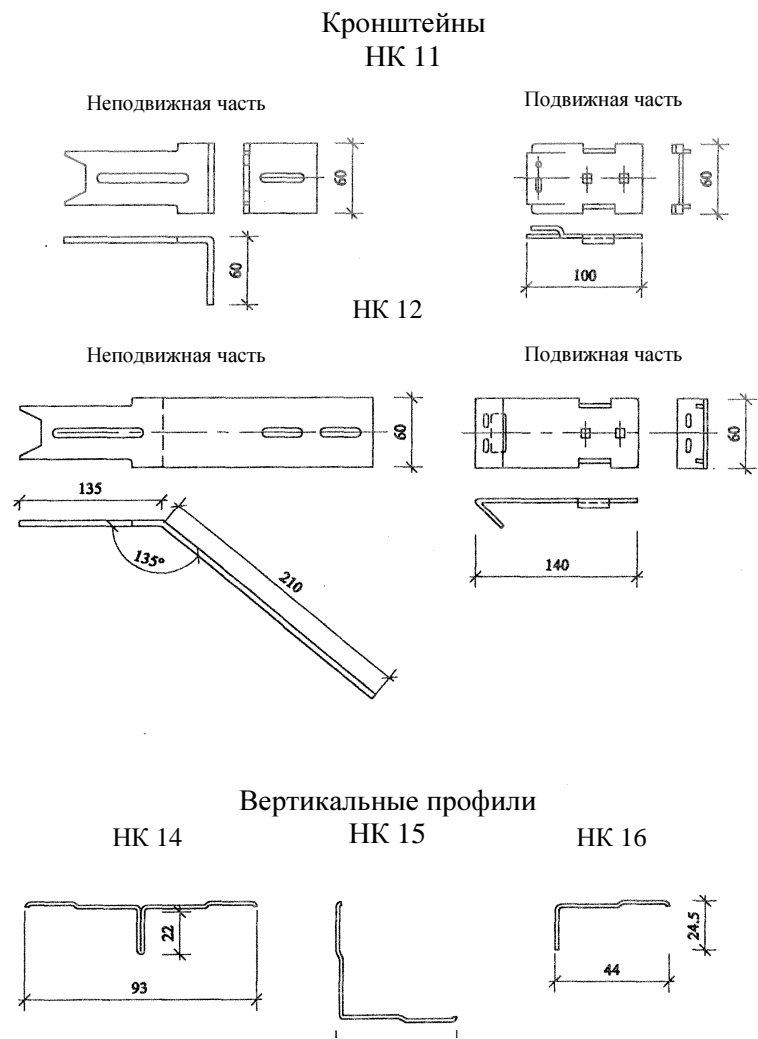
Элементы несущего каркаса фасадной системы Краспан
